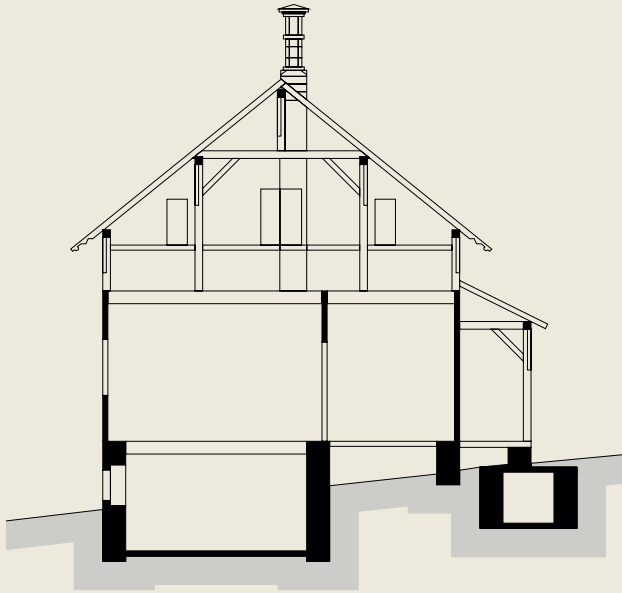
Wohnhaus nach Stöckl-Plan, Schnitt.
